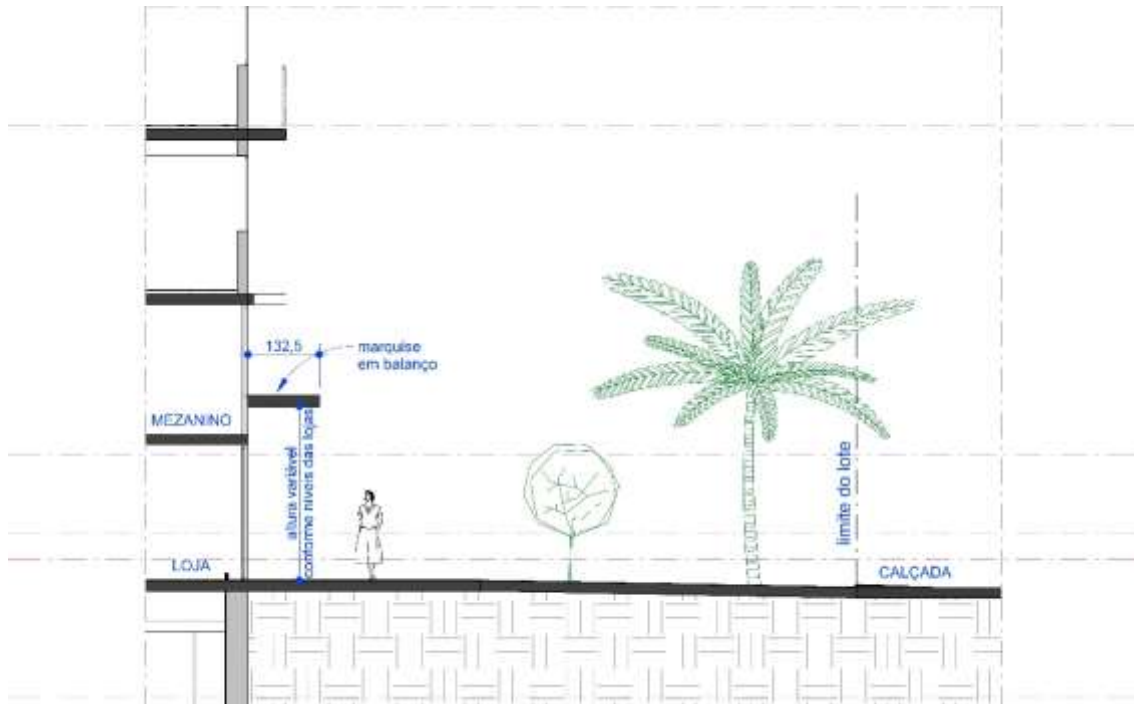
Conceito de Fachada. Fonte: Estudo Prévio, Dávila Arquitetura.
